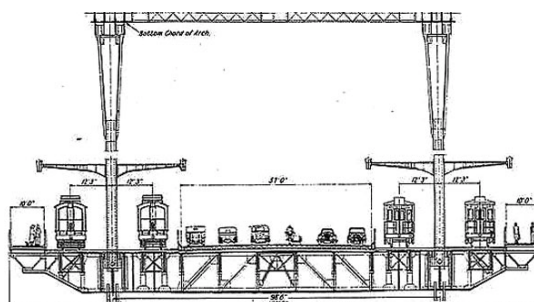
Sydney Harbour Bridge – Secțiune transversală [14]
